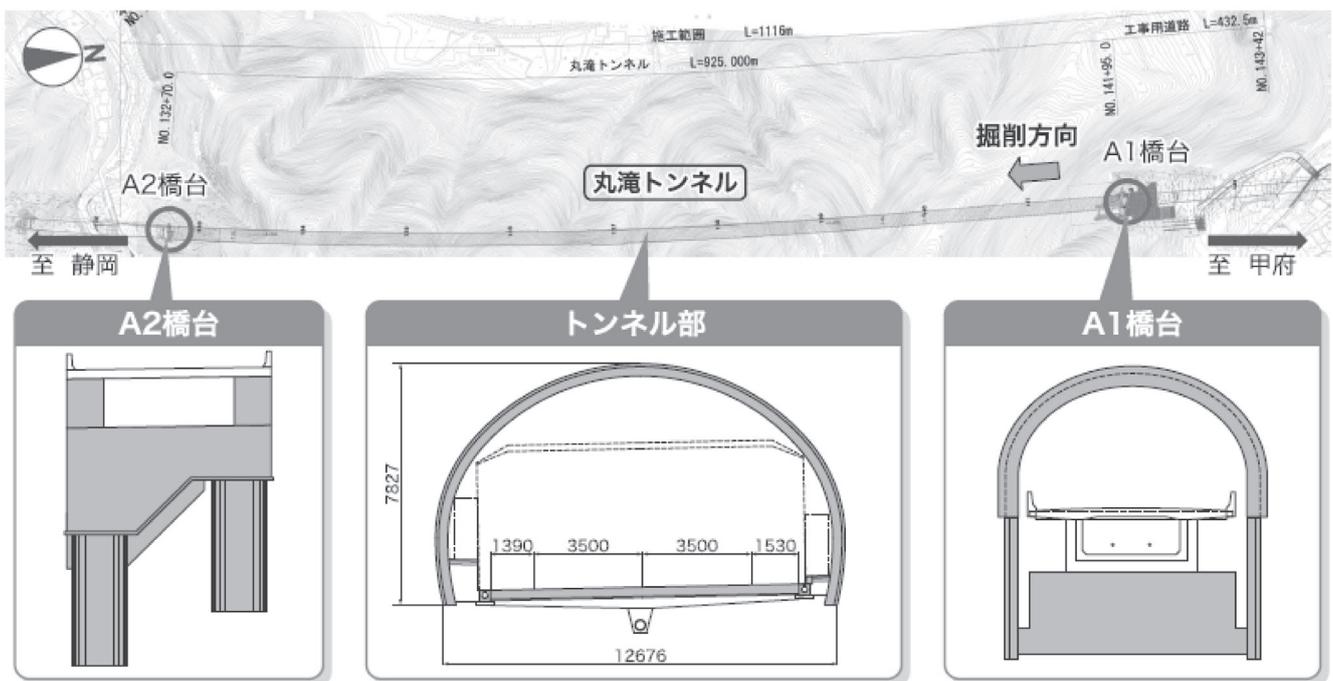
トンネル平面図、トンネル標準断面図、橋台構造図
